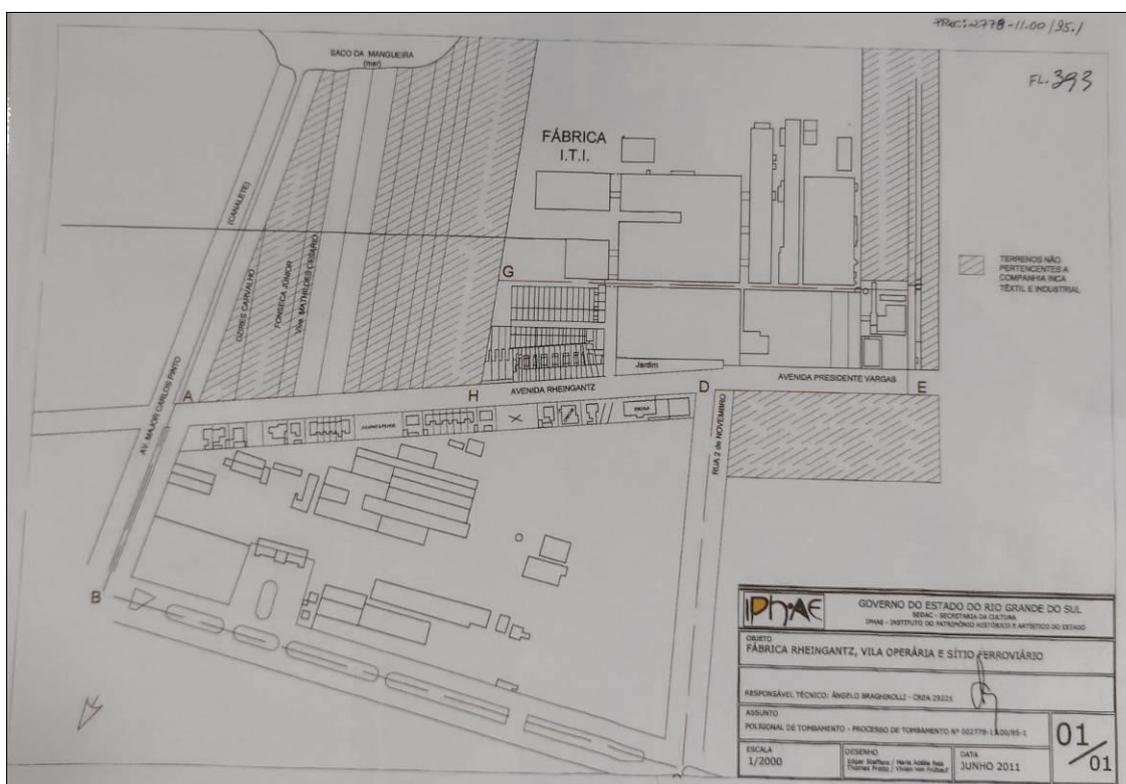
Planta do Complexo Rheingantz. IPHAE, 2011
